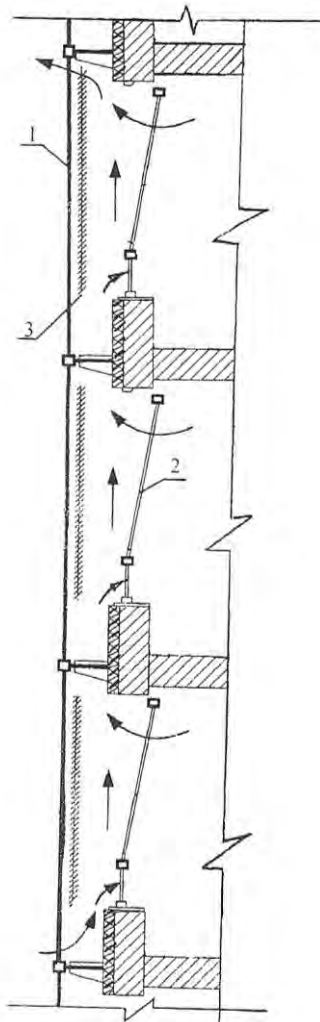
Схема организации естественной вентиляции с использованием «двойного фасада»:
